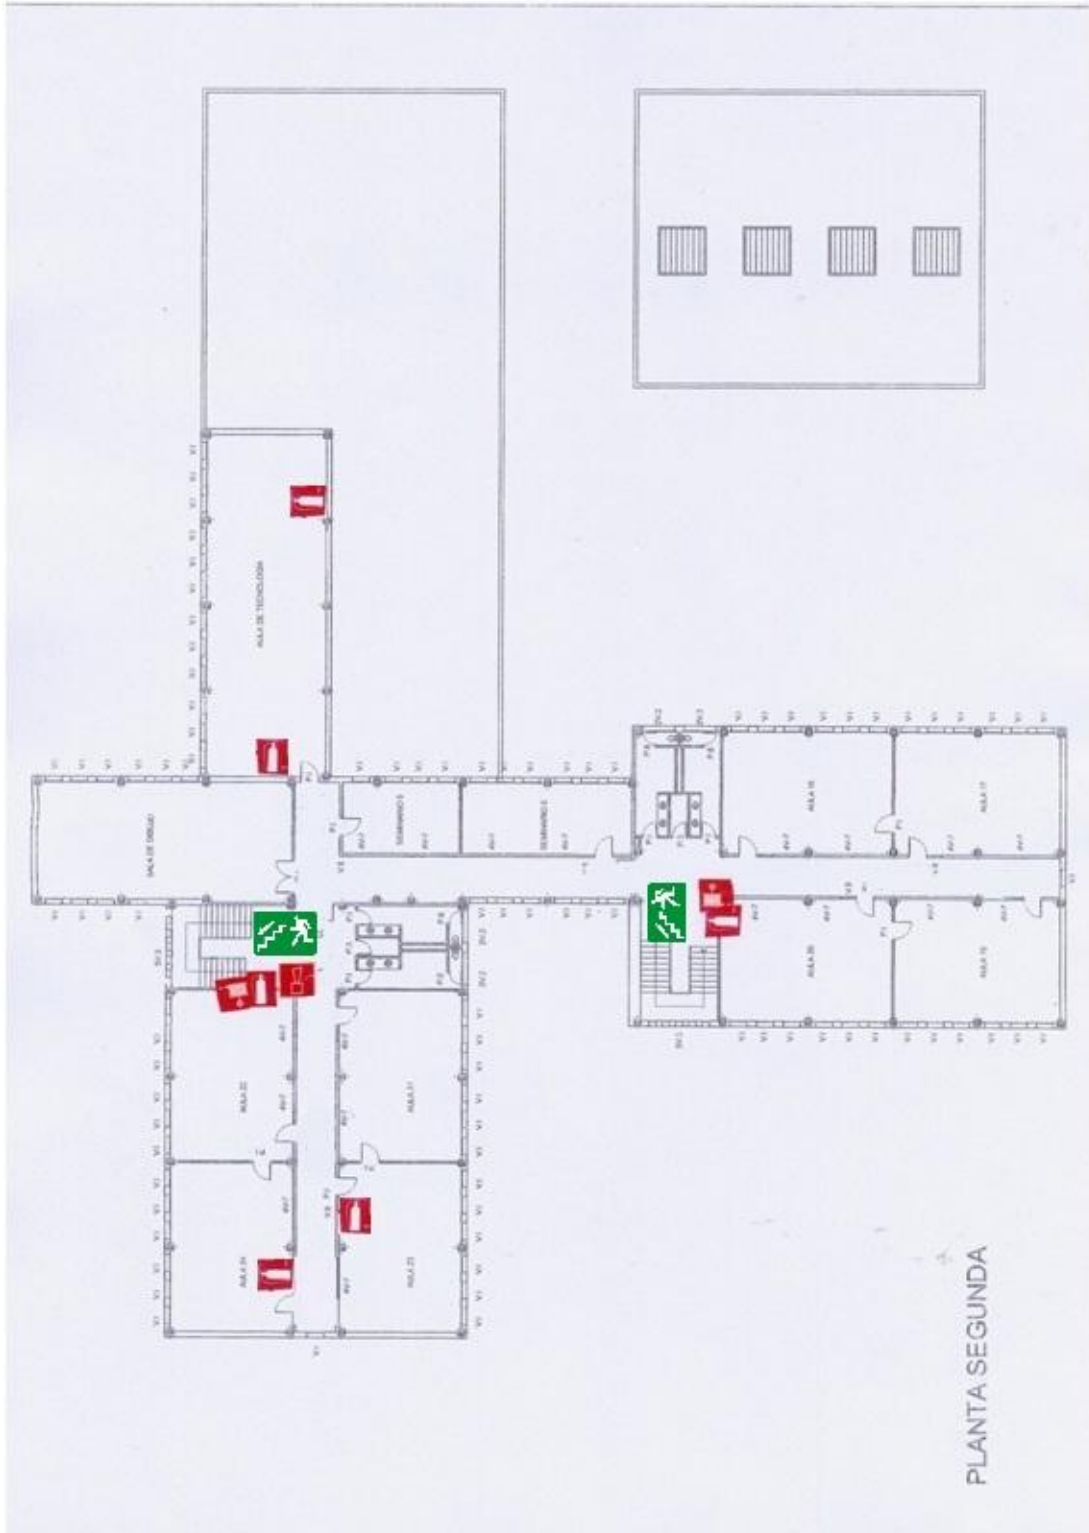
Plano planta segunda I.E.S Cesar Manrique. Fuente: I.E.S Cesar Manrique.
